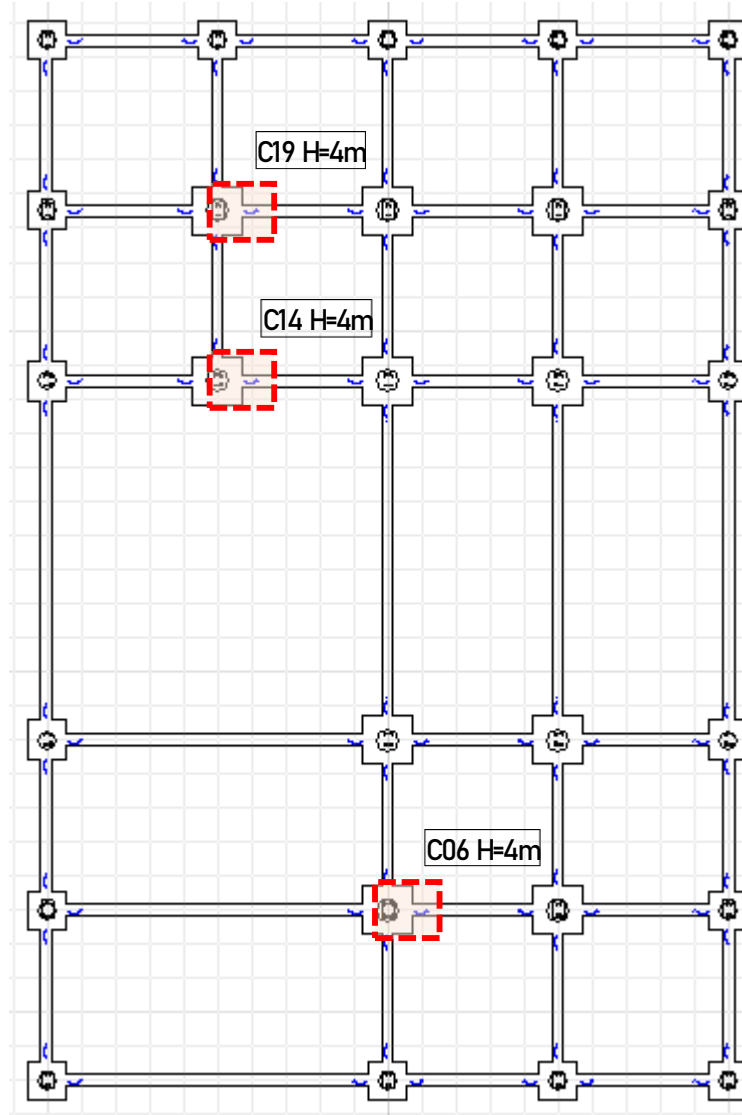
Geometría Modelo CYPE 3D – barras Planta Baja
